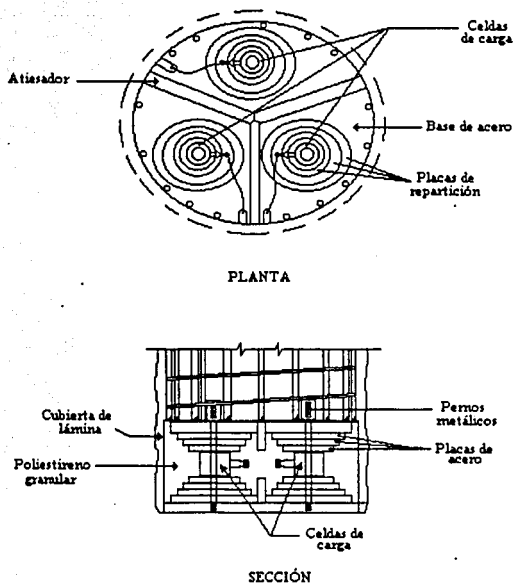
Arreglo de las celdas de carga en la punta de las pilas 181, 196 y 32.
